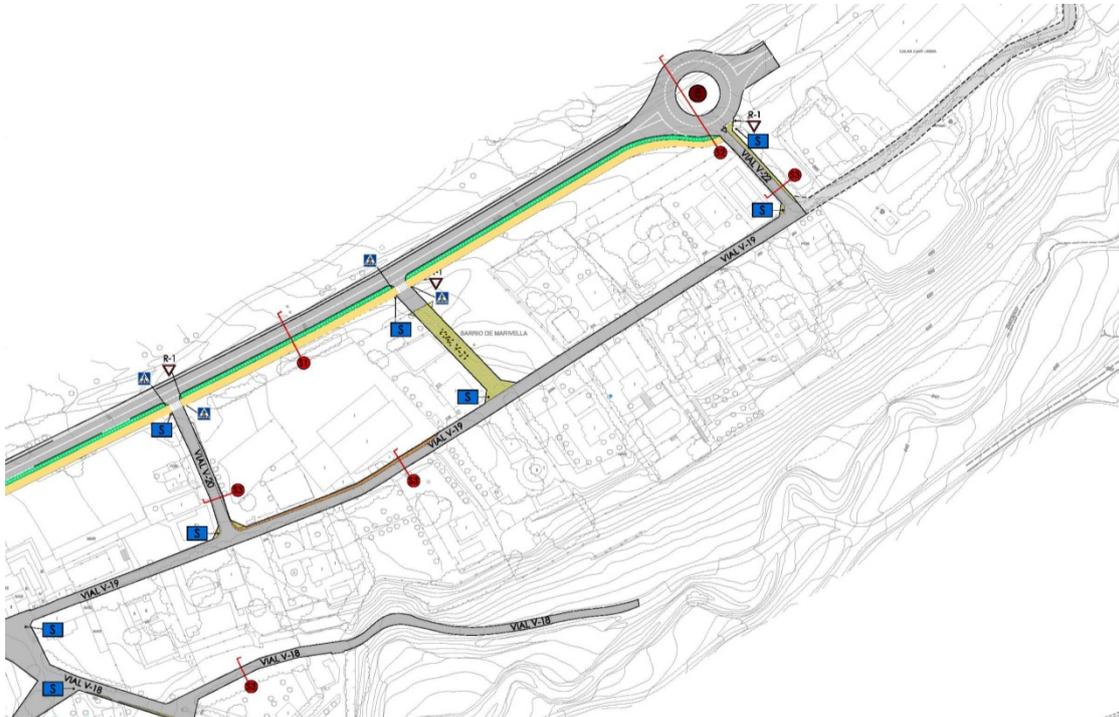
Extracto de plano de desarrollo de pavimentación. Área superior del sector
